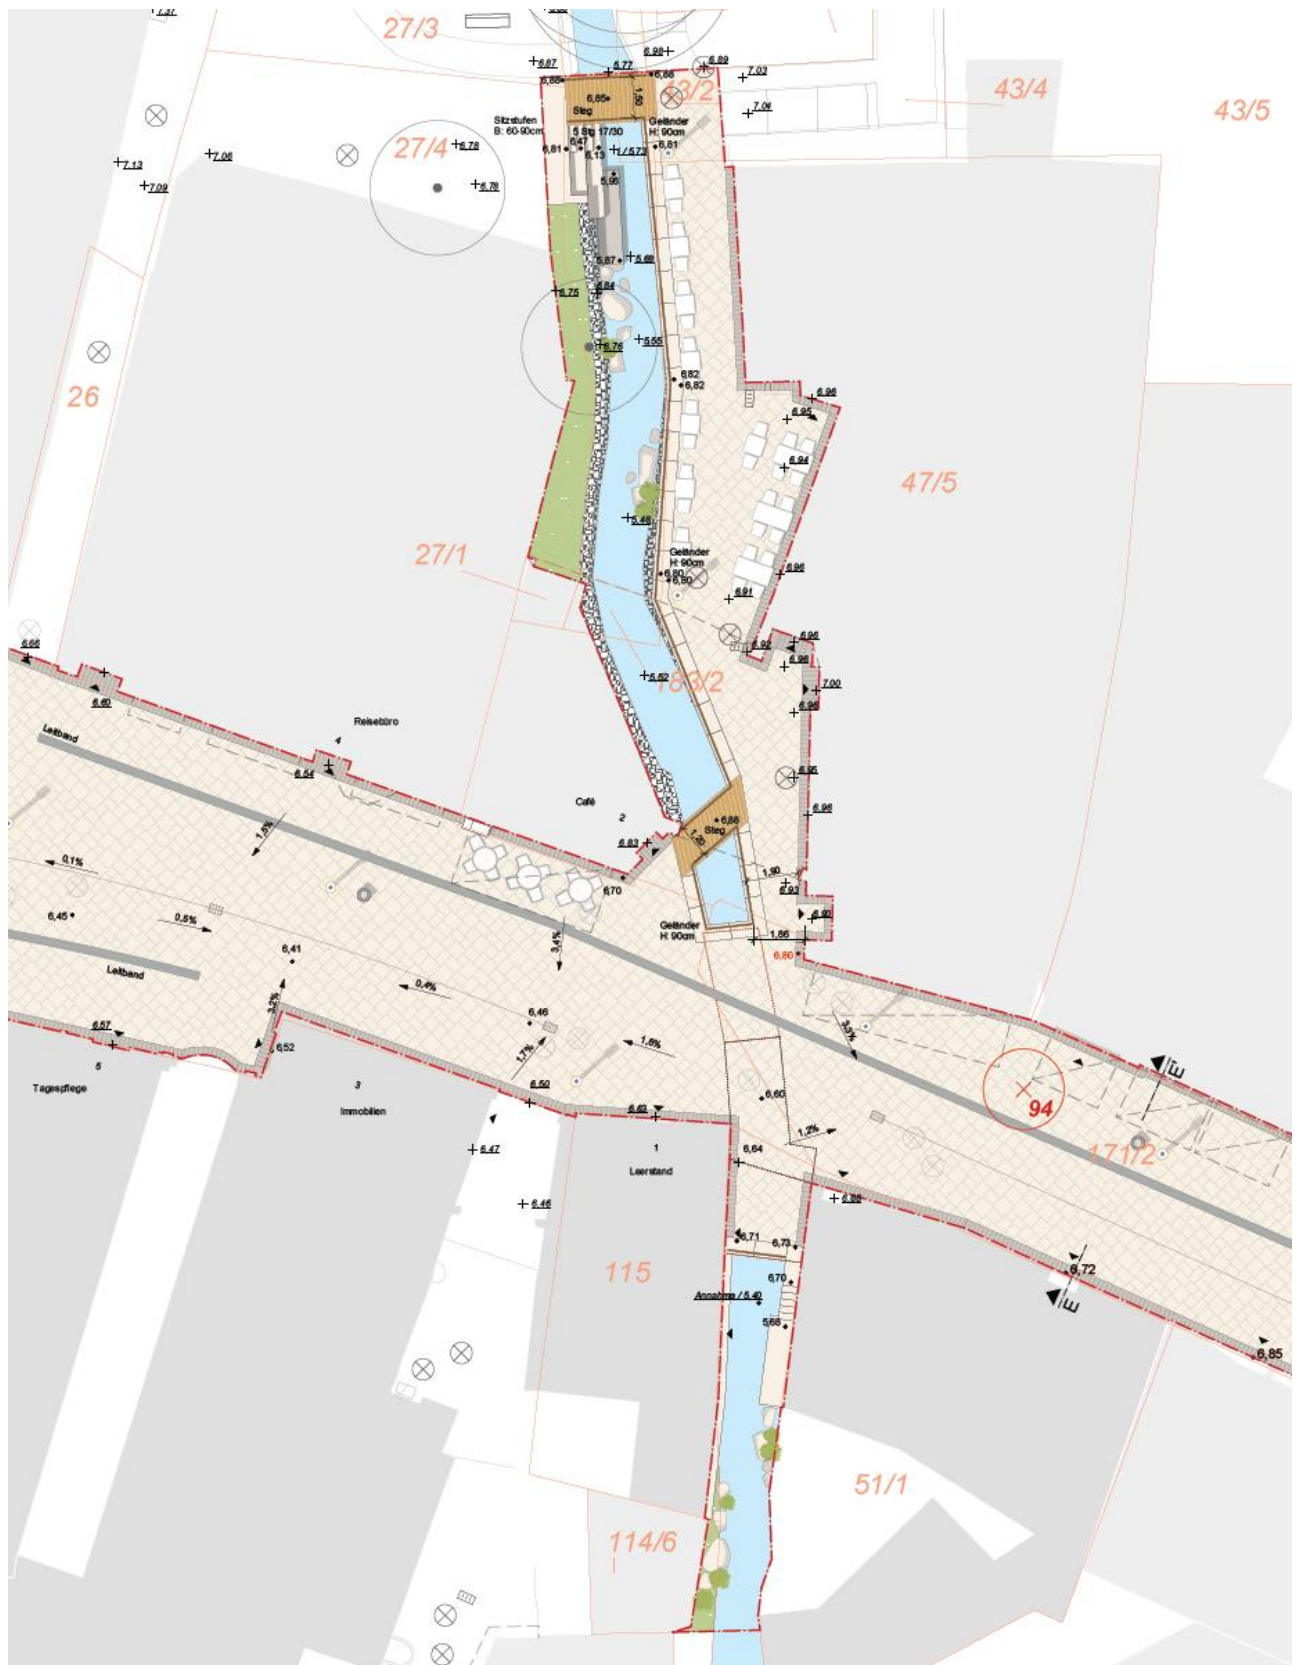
Aktueller Planungsstand Objektplanung Freianlagen Bereich Mühlenbach, capattistaubach | urbane landschaften & iplan nord gmbh (ARGE Erschließungsanlagen Schleswig)
